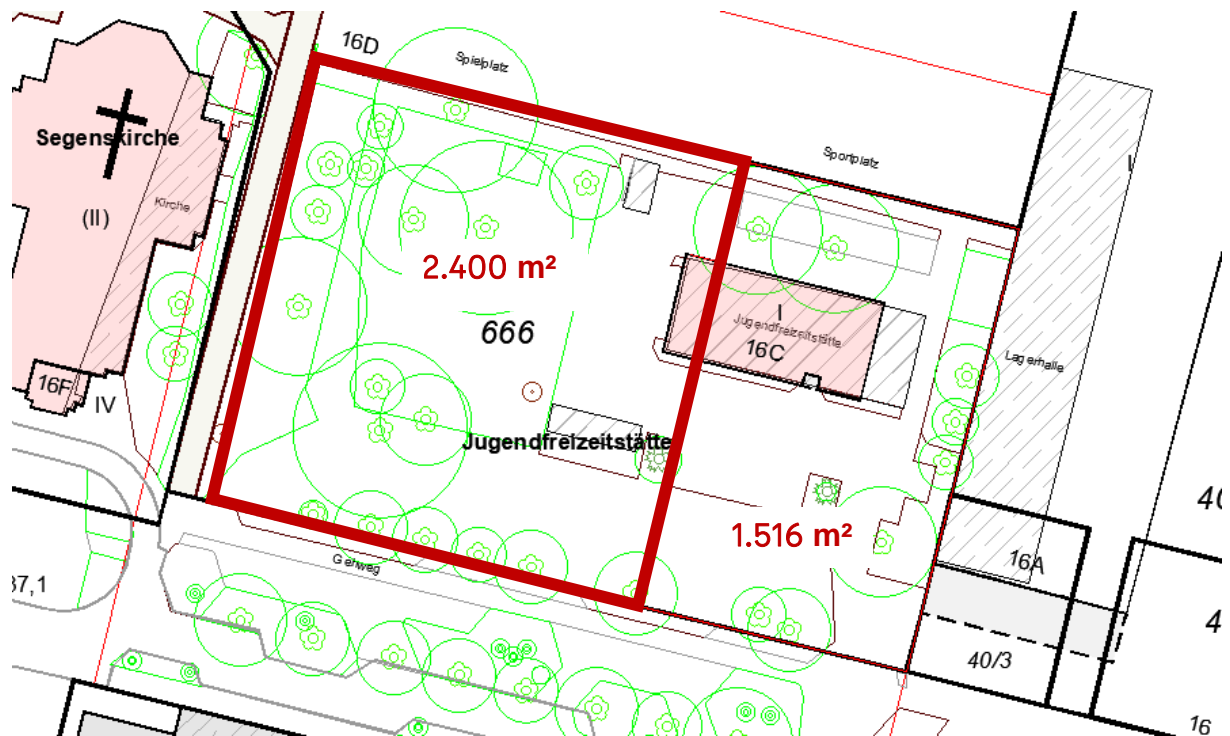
Wettbewerbsgrundstück | Grundlage Quelle: Vermesserplan
